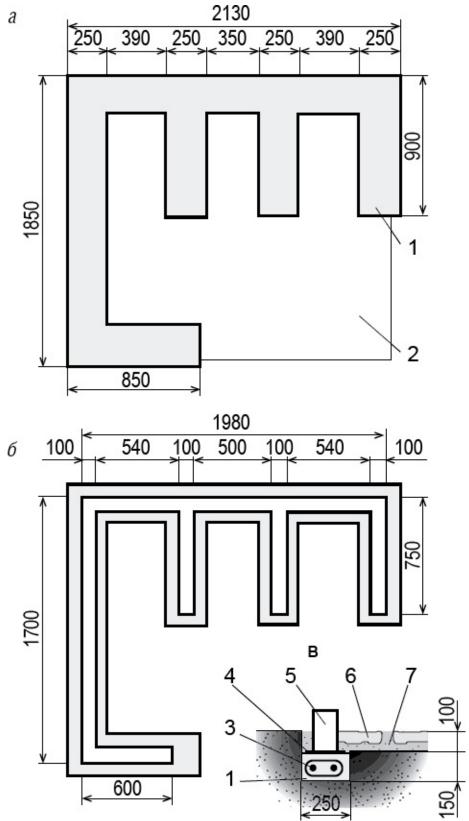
Устройство фундамента для беседки с барбекю: a – план разбивки ленточного фундамента; δ – расположение блоков
